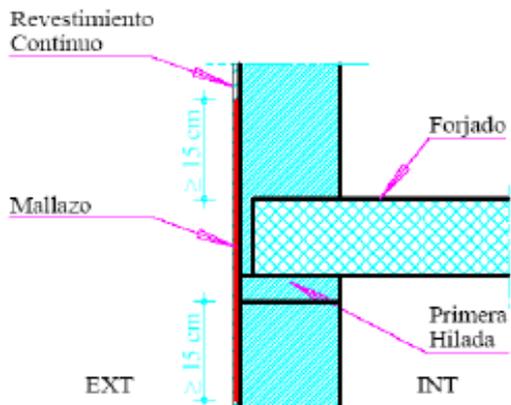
Encuentros de fachada con los forjados. Fuente CTE
